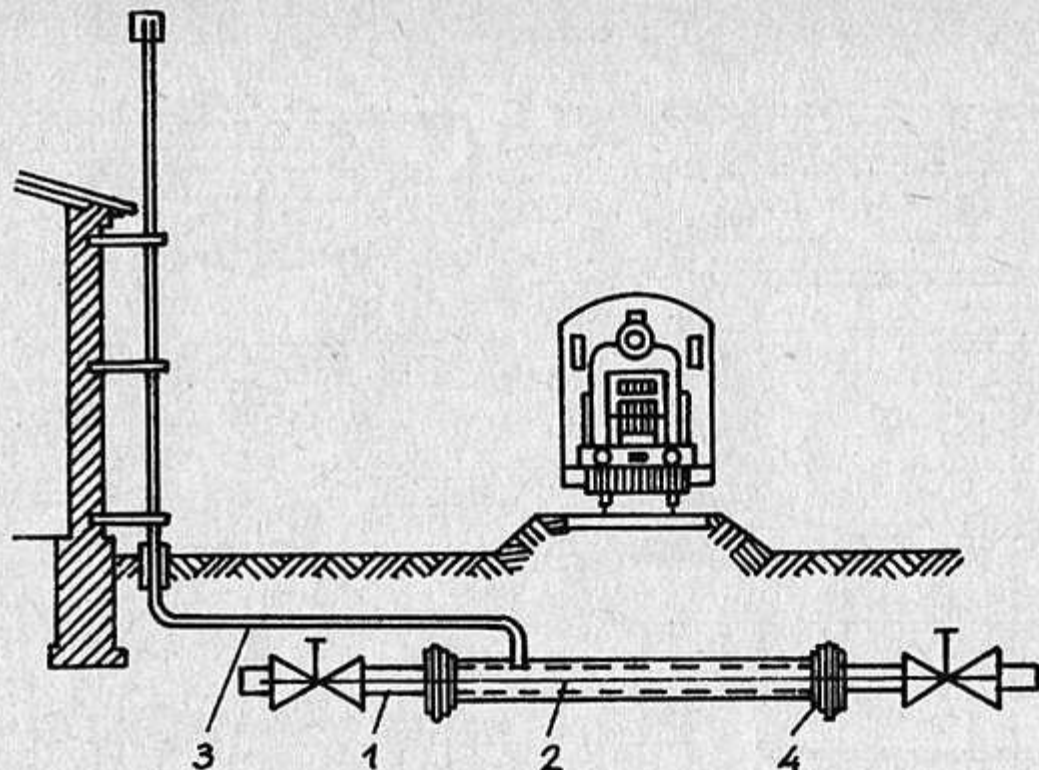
Kreuzung von Eisenbahn- und Straßenbahngleisen durch eine Gasleitung
